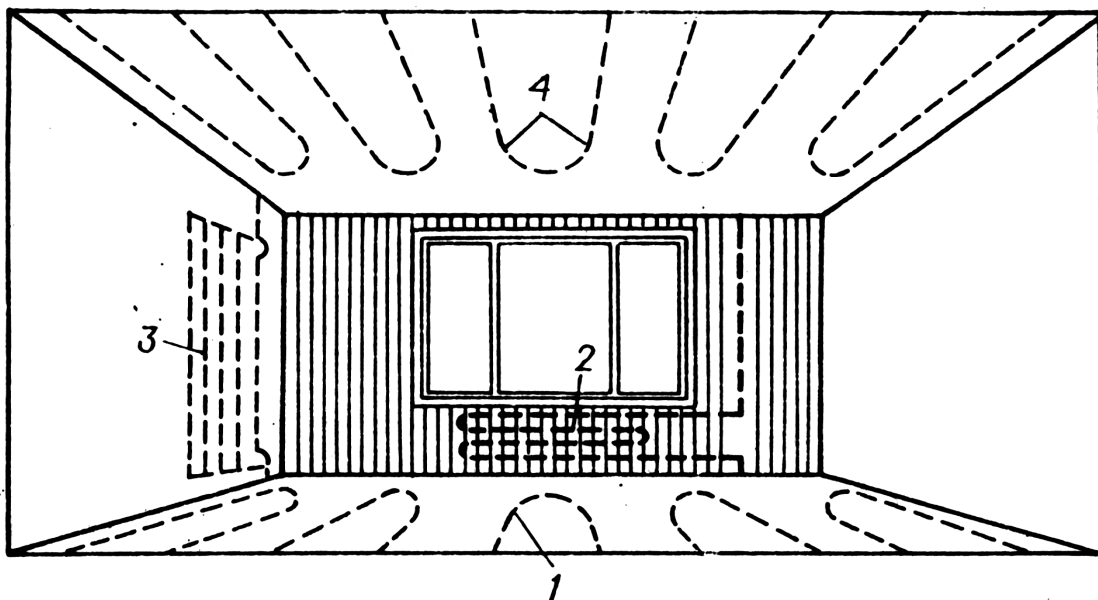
Схема размещения отопительных элементов в ограждающих конструкциях здания
